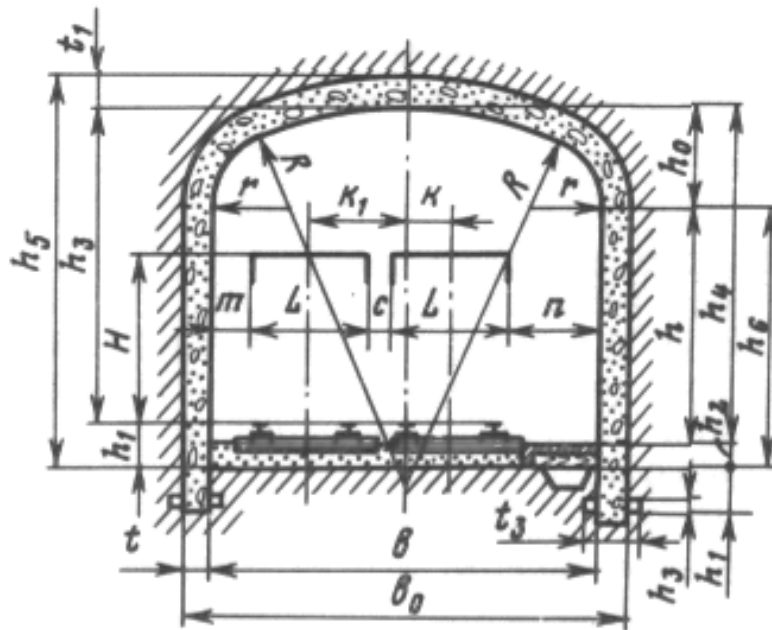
Типовое сечение двухпутной выработки с монолитной бетонной крепью и локомотивной откаткой породы
